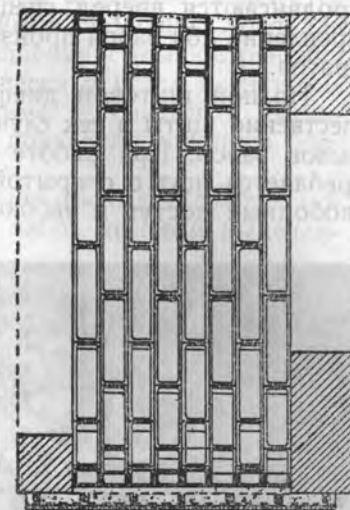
Закрепление камеры для сборки щита чугунными тубингами диаметр камеры 6,40 м.
